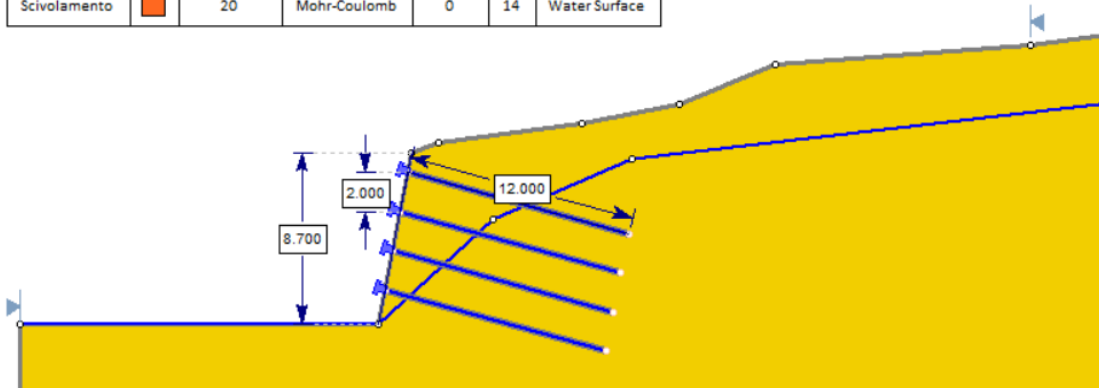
Modello di calcolo SLIDE – Sezione 1
